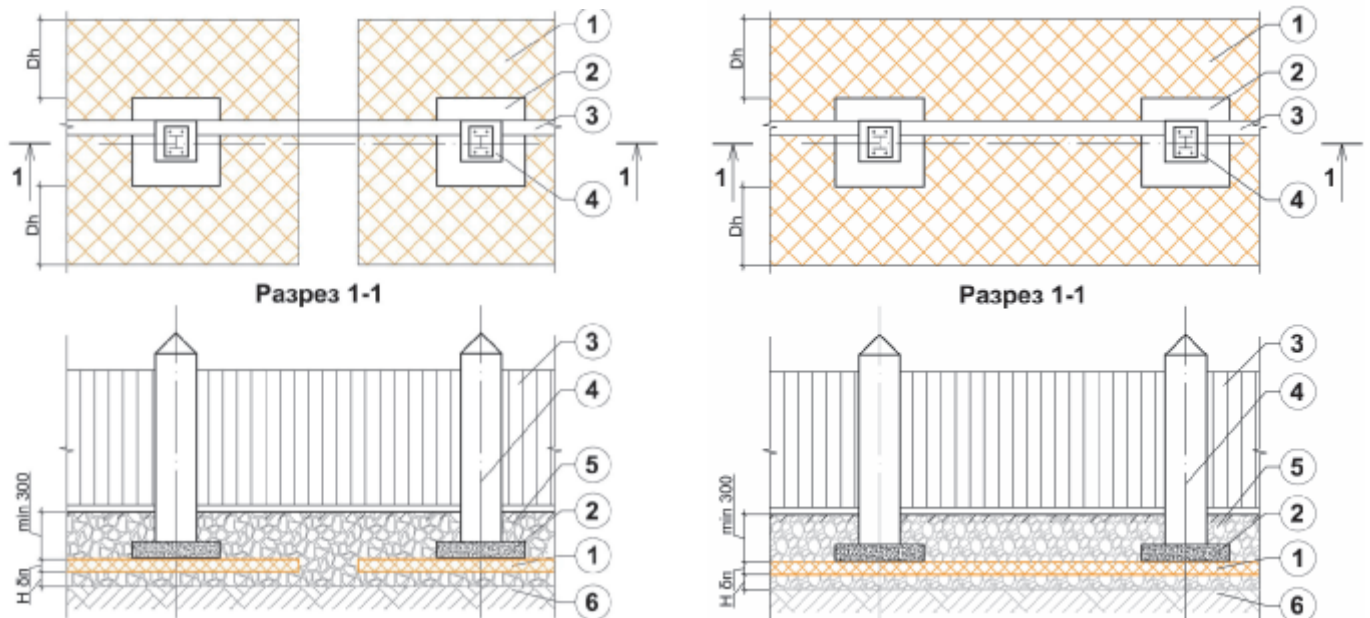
Принципиальные схемы утепления фундамента опор садового ограждения.
